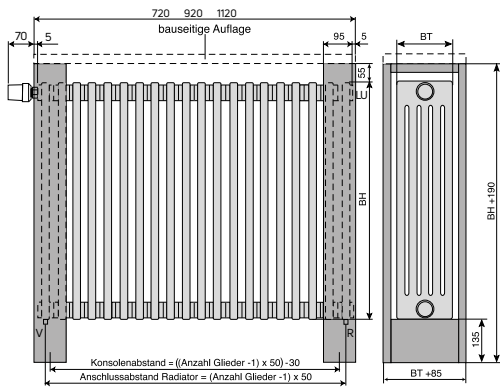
Delta Bar – Anschluss und Befestigung. V=Vorlauf, R=Rücklauf, LU=Entlüftung; BL= Baulänge Heizkörper; BT=Bautiefe Heizkörper; BH=Bauhöhe Heizkörper (Auflage "Buche-Multiplex" als Zubehör erhältlich)
